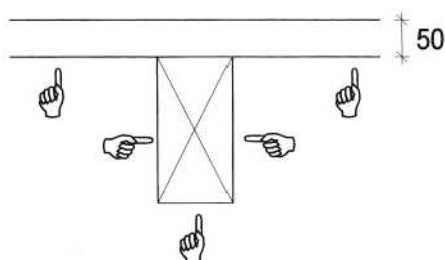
Brandbeanspruchung einer sichtbaren Balkenlage
